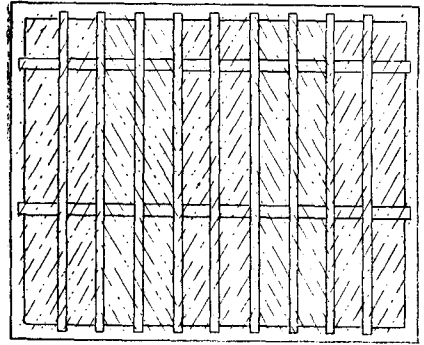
План деревянного перекрытия крыши дома. Пунктир с точкой обозначает настил из жердей, уложенных „в ёлку“ поверх балок
